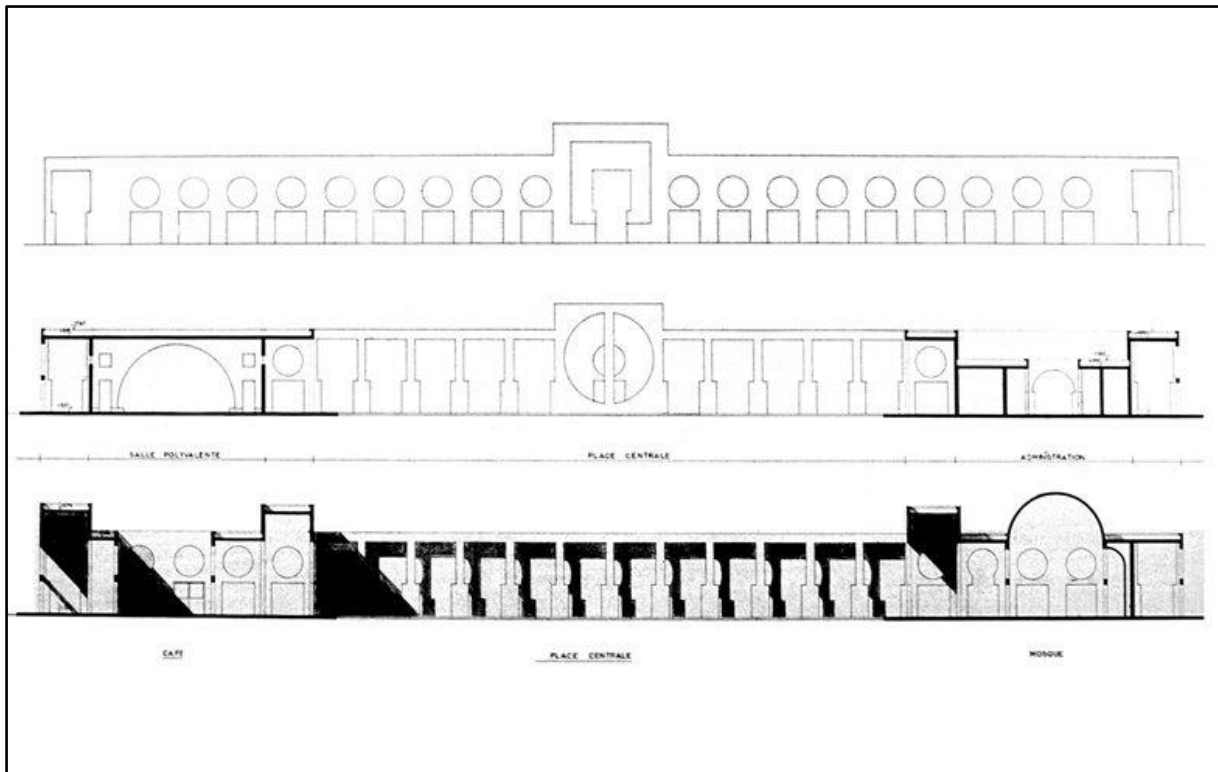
façade et coupe de l'équipement <http://www.ricardobofill.com/>
